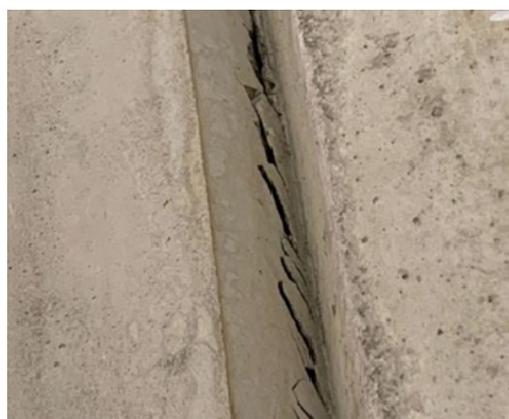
コンクリートの収縮による目地の開きで生じたひび割れ
